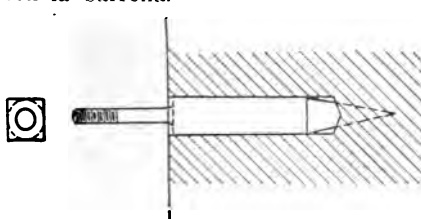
En muros de hormigón las espigas de acero se introducen en un agujero redondo abierto de antemano.
